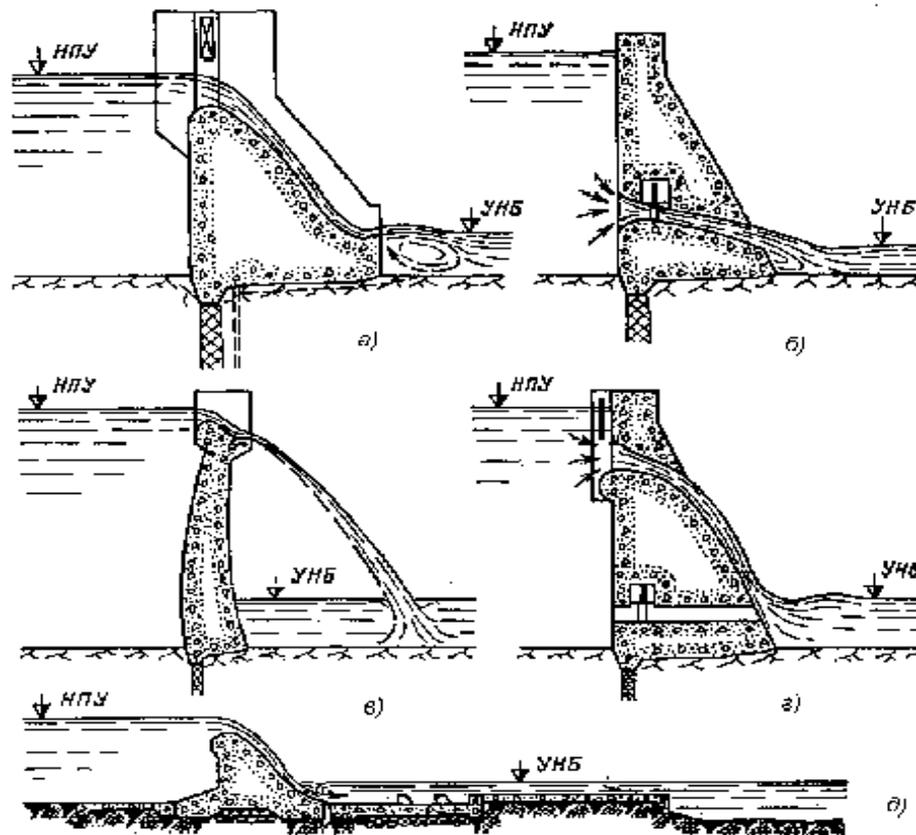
Конструкции бетонных и железобетонных плотин на скальных основаниях
